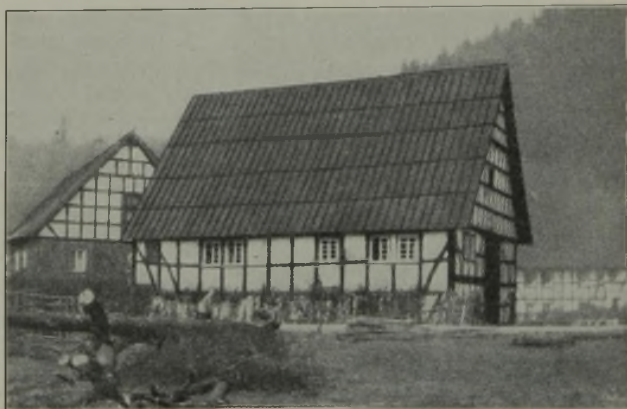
Bauernhaus mit sauber eingedeckter Dachfläche.
